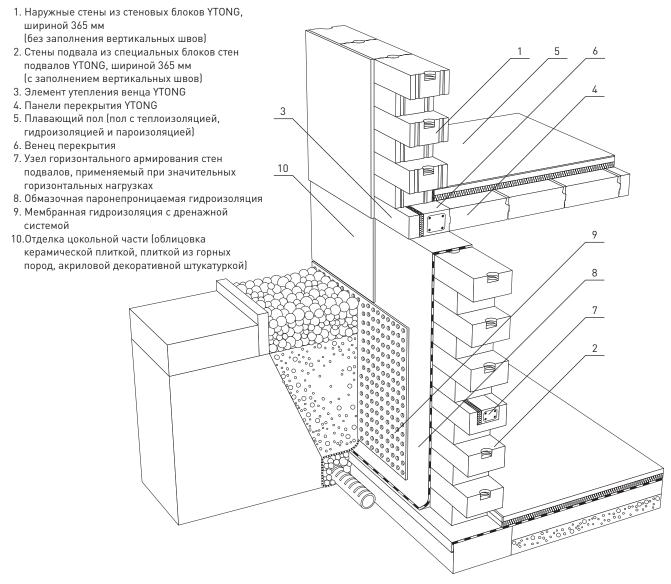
Общий вид фундамента с подвалом, с полом на грунте, цоколем и стеной
